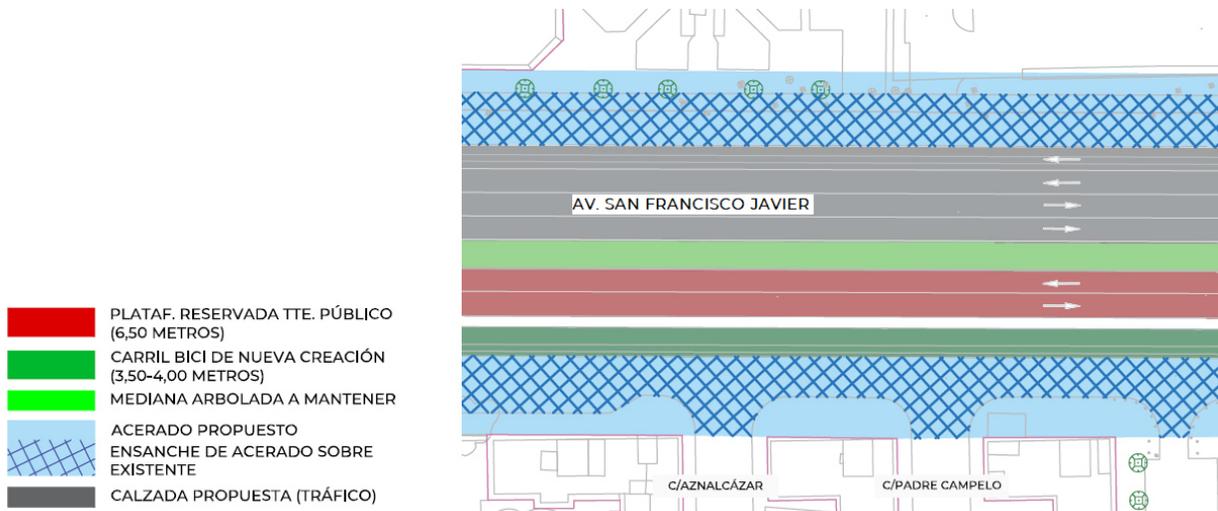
Extracto de plano de planta preparados por sevillasemueve como alternativa de plataforma reservada
